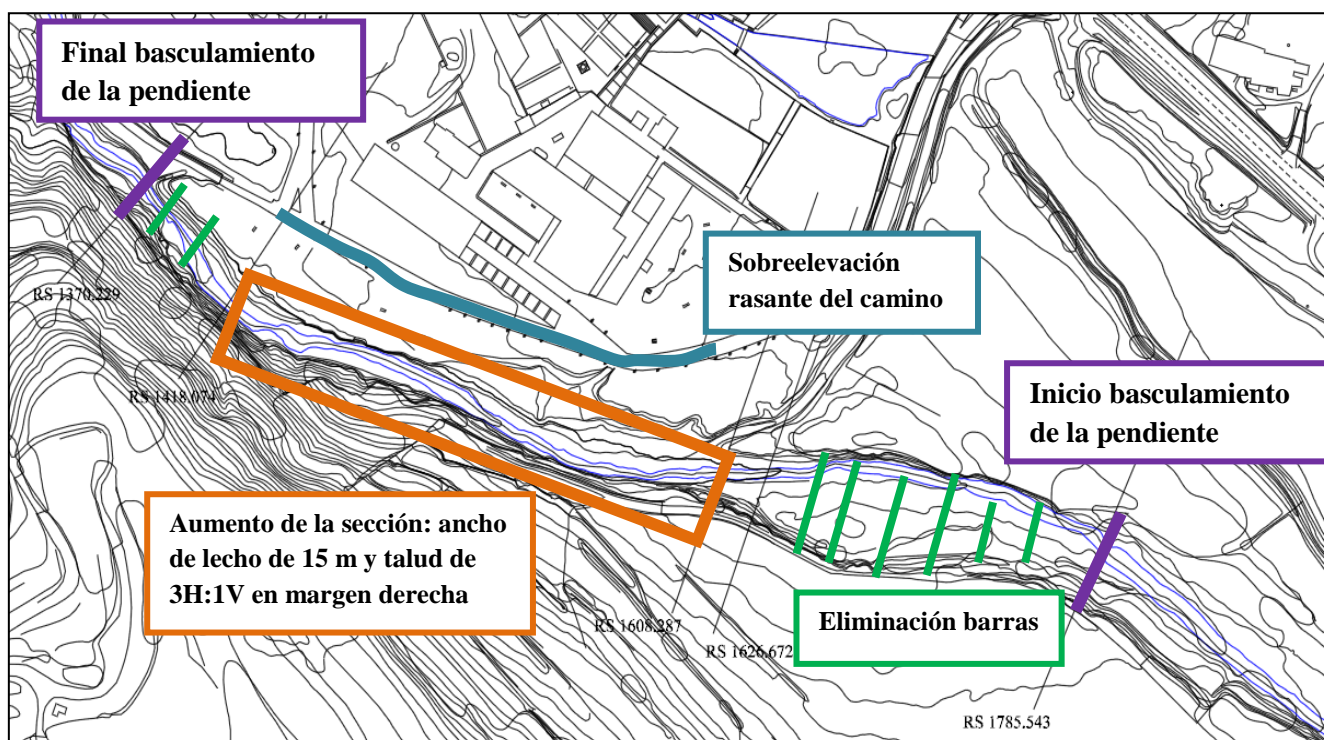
Esquema en planta de las actuaciones para la alternativa 2
